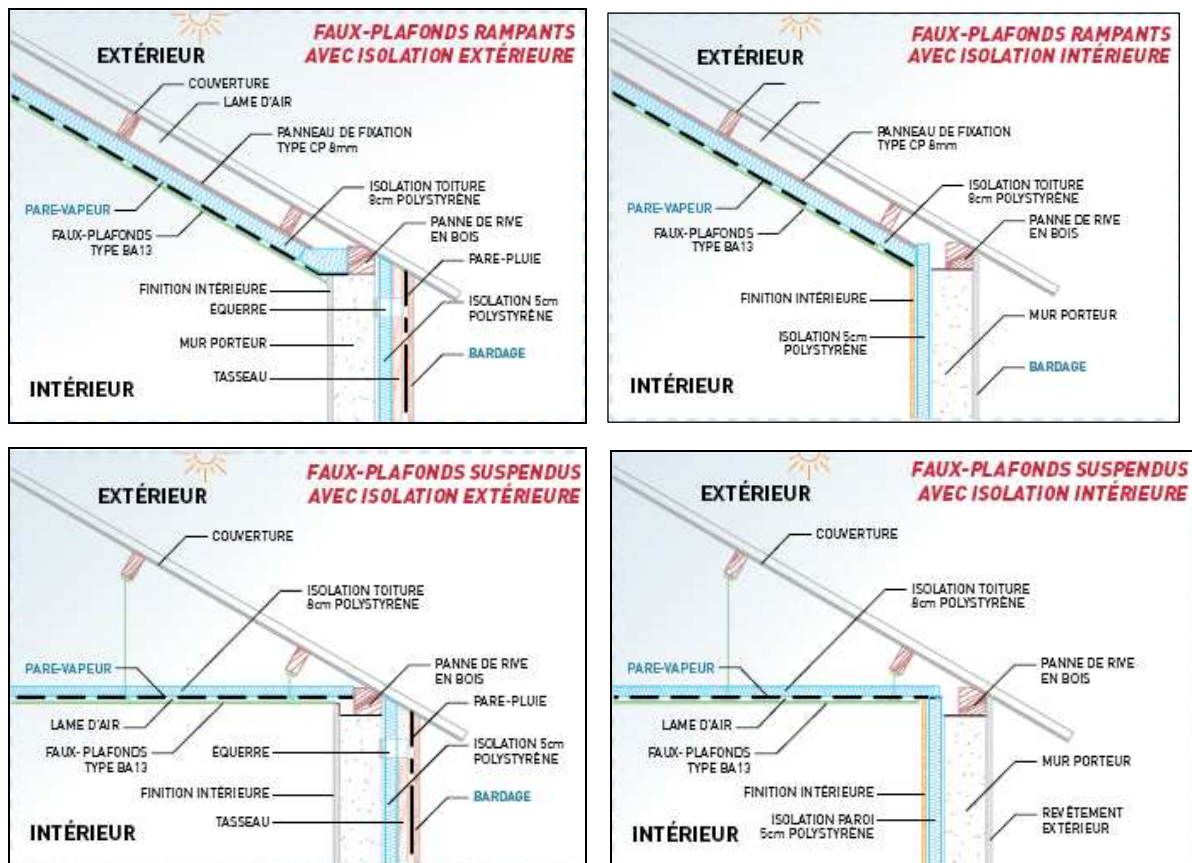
coupe d'isolation toiture, avec faux plafond rampants ou suspendus
